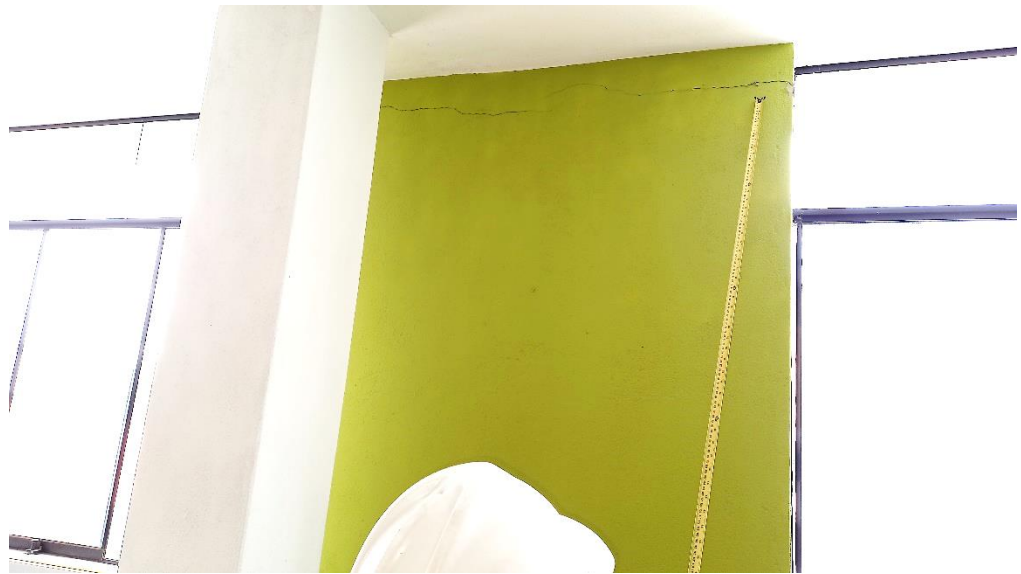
Fisura en muro del segundo piso del pabellón C
